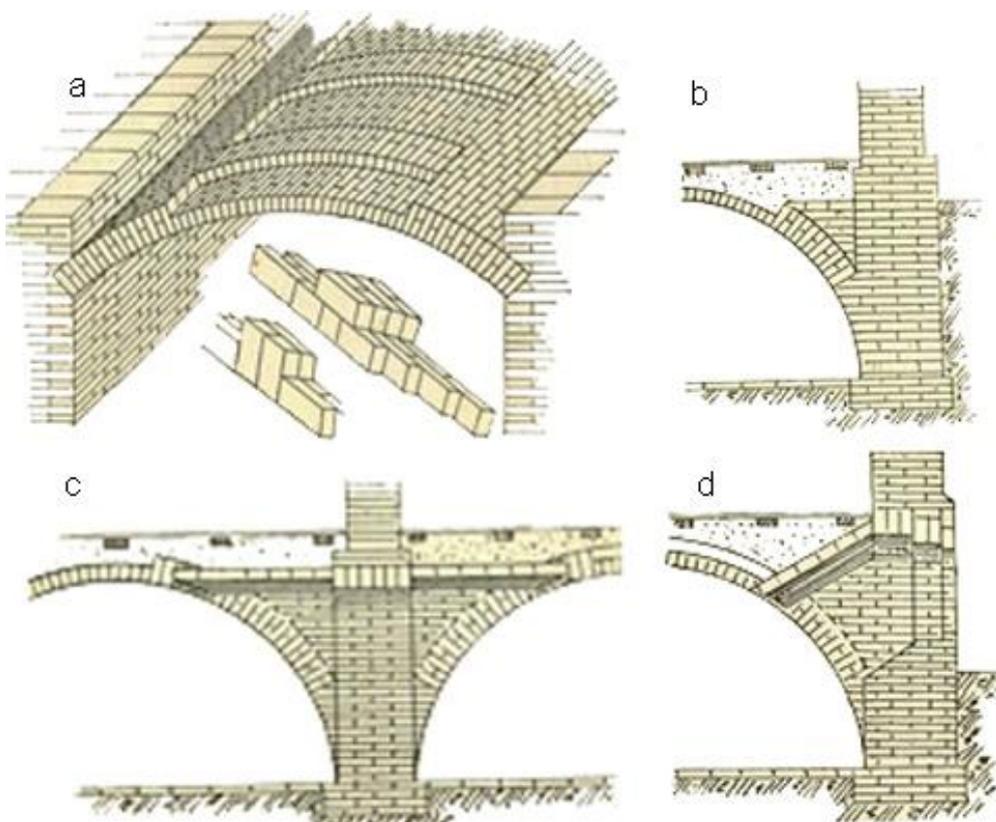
Перекрытия с применением коробового свода: а – свод с гуртами (усилениями); б – свод в подвальном перекрытии; с – свод с распалубками в примыкании к внутренней стене для организации дверного проема; d – коробовый свод с распалубкой для устройства оконного проема в наружной стене [32]
